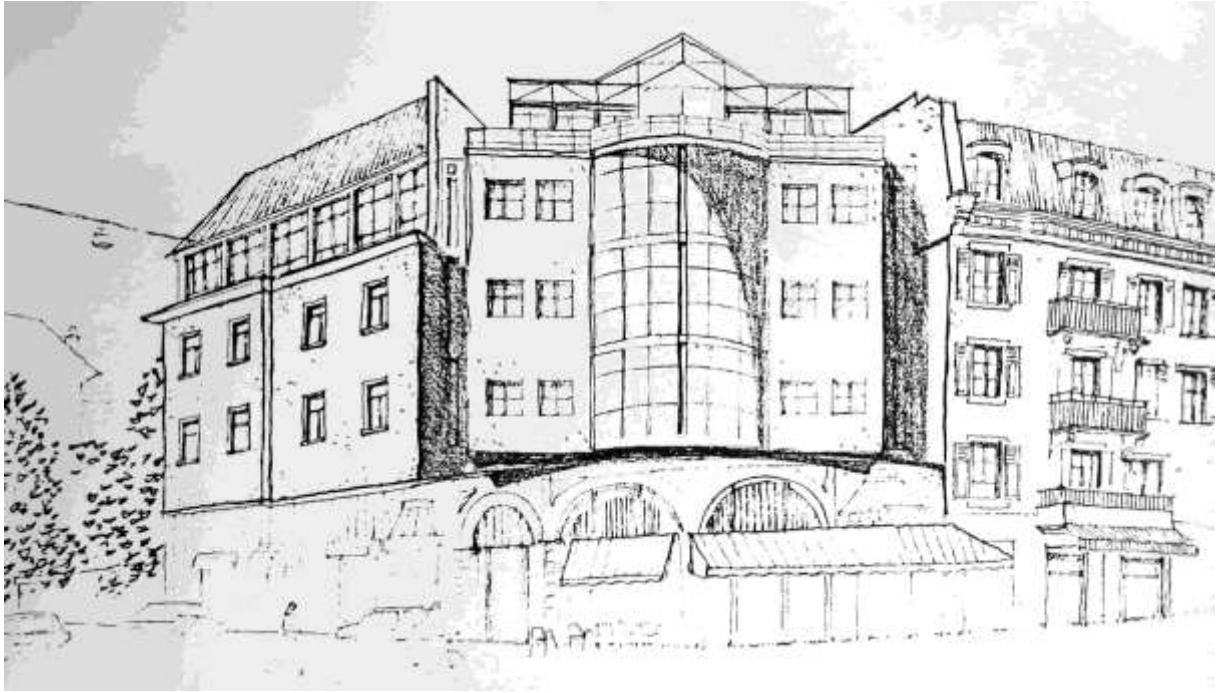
Projet de surélévation de l'hôtel Touring, J. Nicollier & R. Pilloud architectes, 1986 (NICOLLIER J. et PILLOUD, R., cf. bibliographie).
